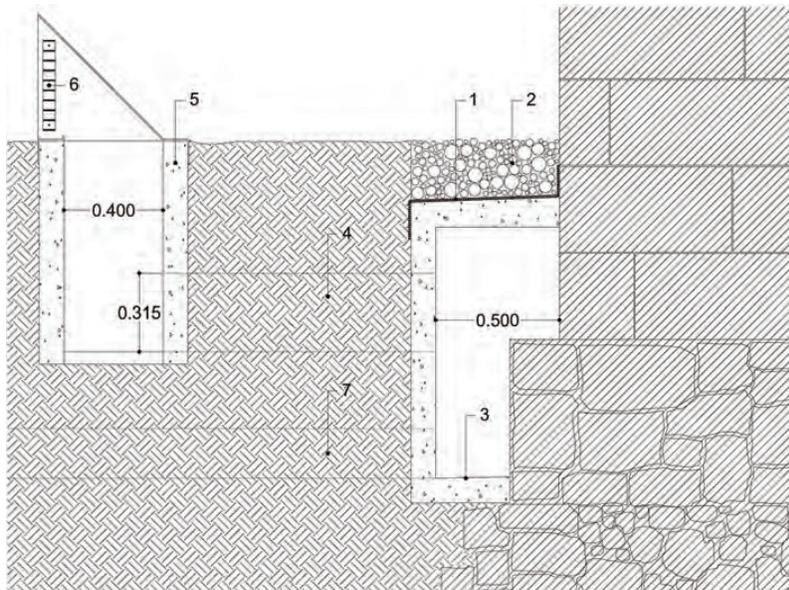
Pormenor do canal do sistema exterior de ventilação da base das paredes
